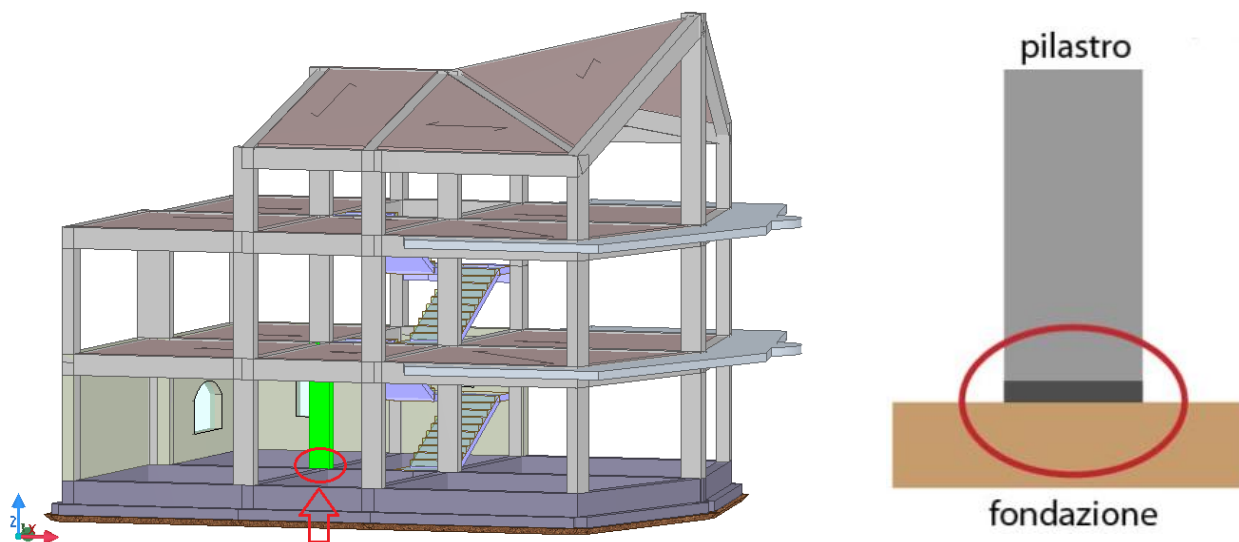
Vista 3D - pilastro oggetto di verifica
